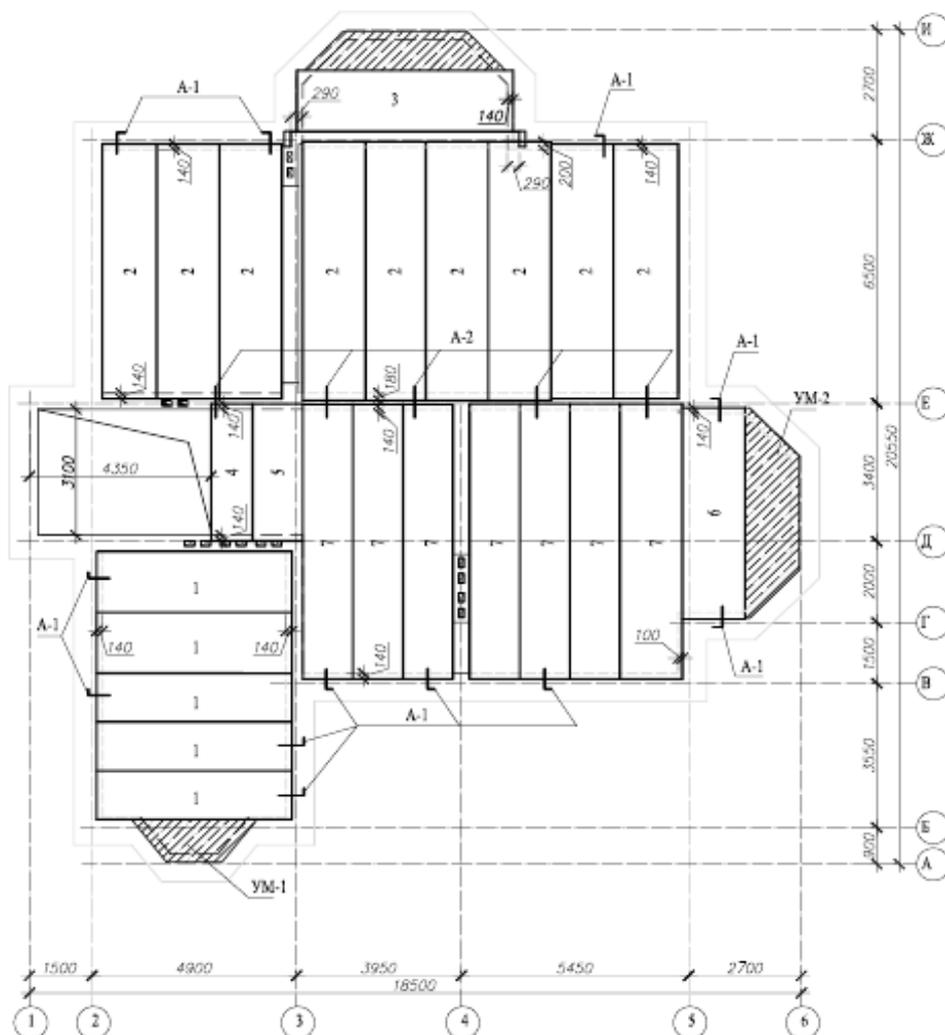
Пример оформления схемы расположения плит перекрытия малоэтажного жилого дома
